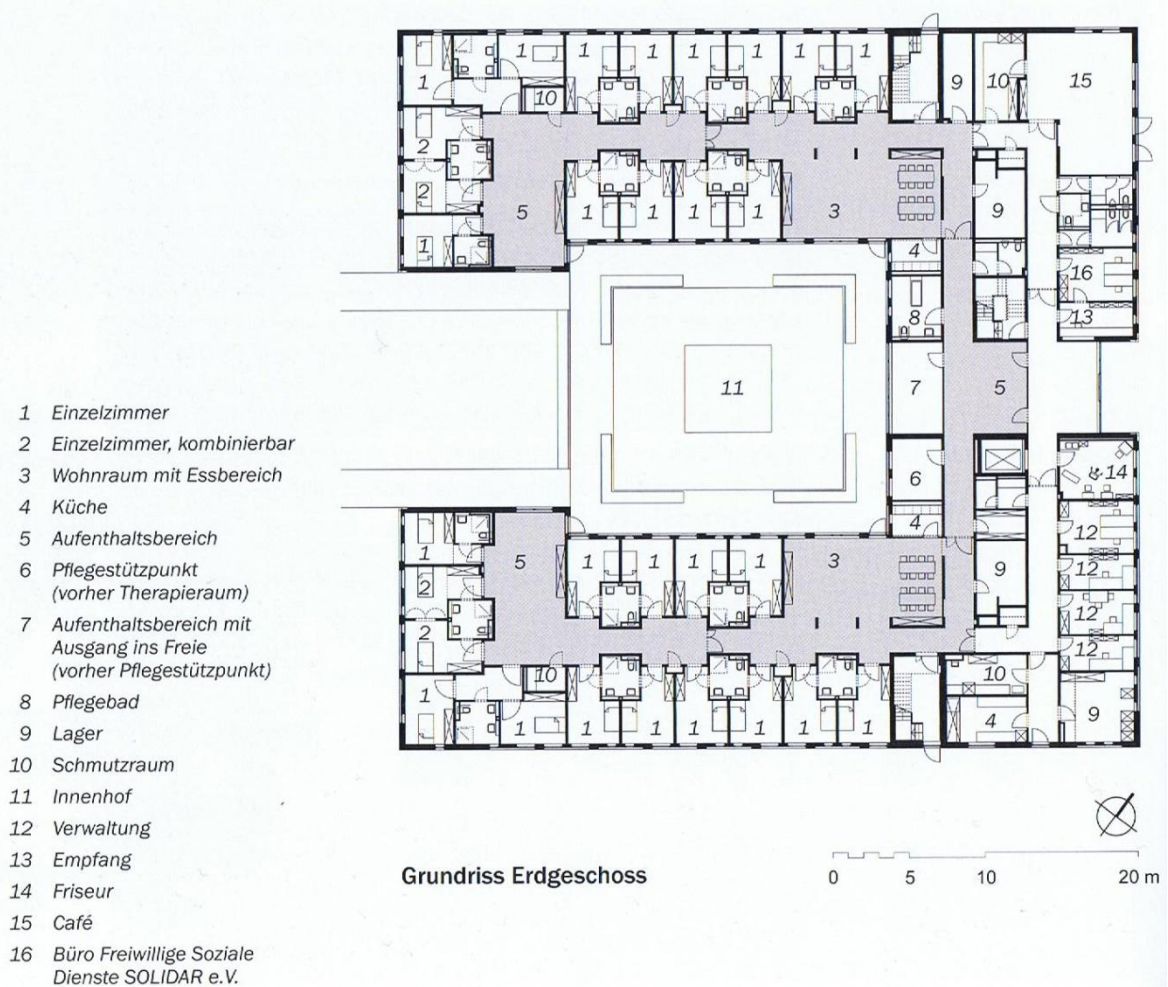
Grundriss EG, Haus im Park, Bremerhaven
